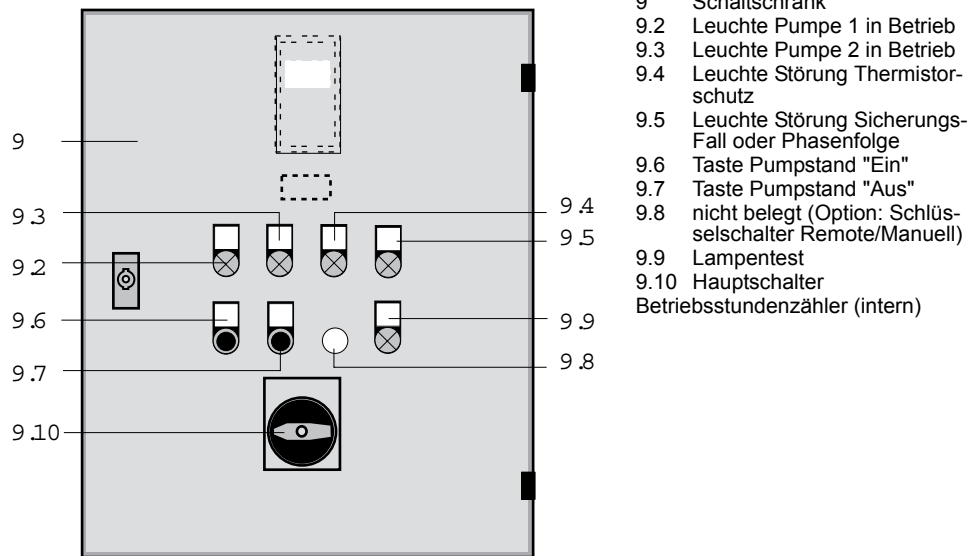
Beispiel für Ausführung mit Schaltschrank
